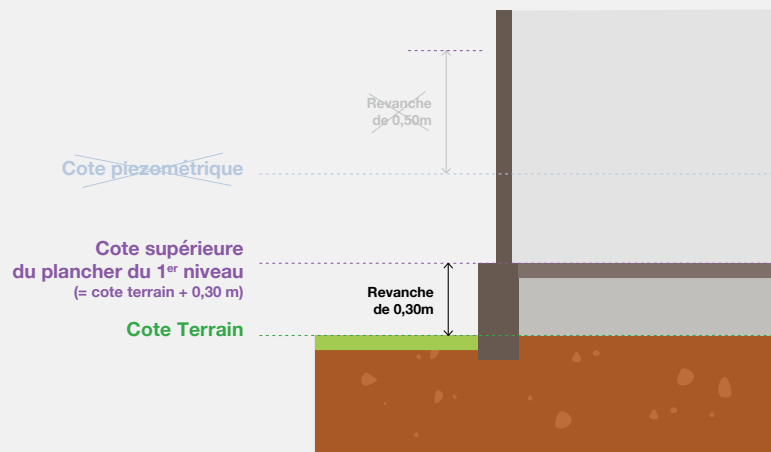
Cote du plancher du 1^{er} niveau = cote du terrain + 0,30 m (cas n°3).
